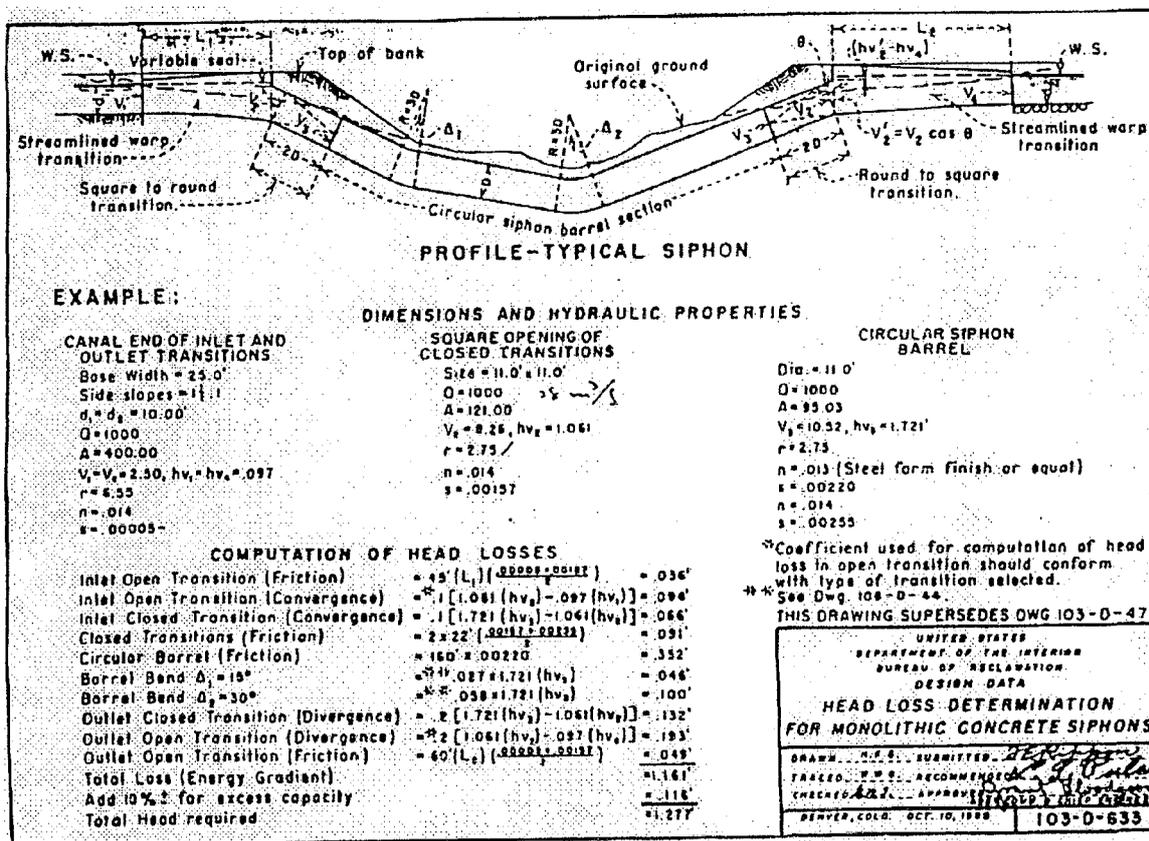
Head Loss Determination for Monolithic Concrete Siphons
